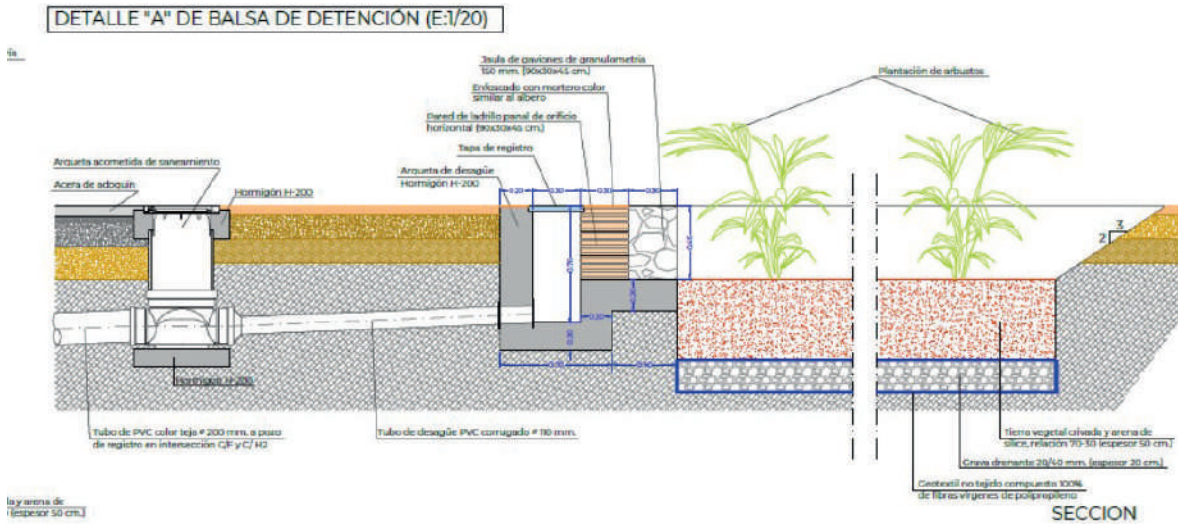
Diseño de la balsa de infiltración del proyecto de urbanización. Fuente: Ayuntamiento de Murcia
